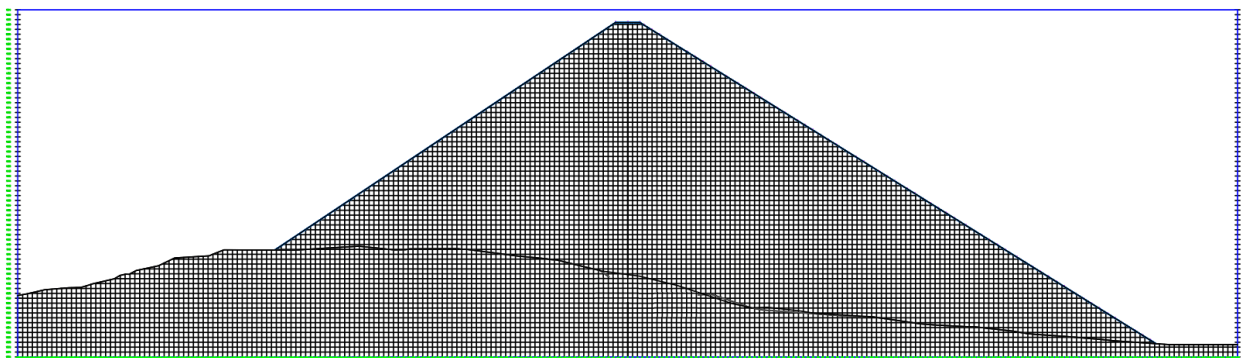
Sección Transversal Ejemplo Presa CFRD La Tranca, Civil 3D
